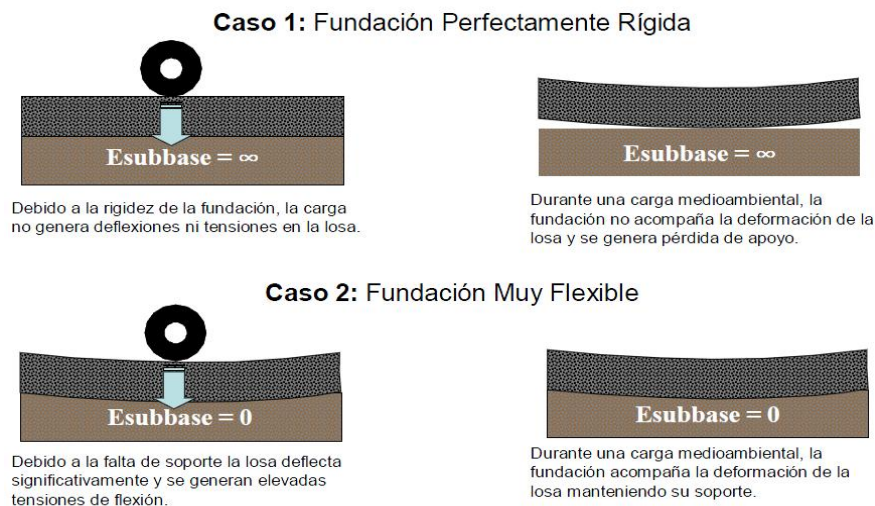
Influencia de la rigidez de apoyo en las tensiones generadas
